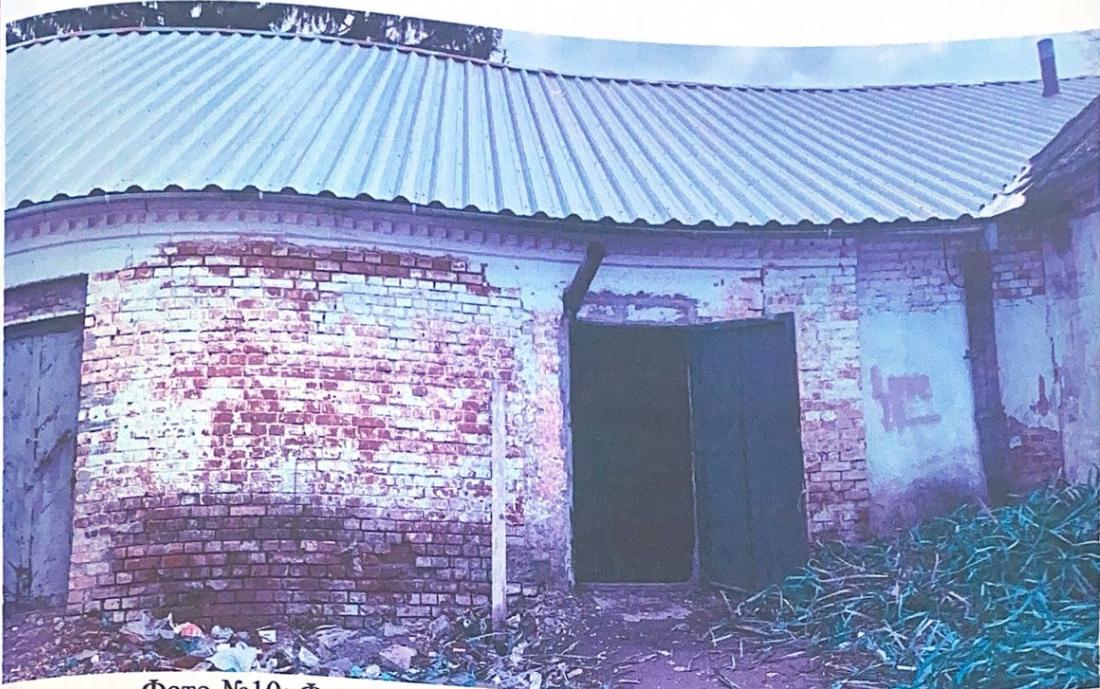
Фрагмент фасаду прибудови літ.«А1» в осях В-Б.
